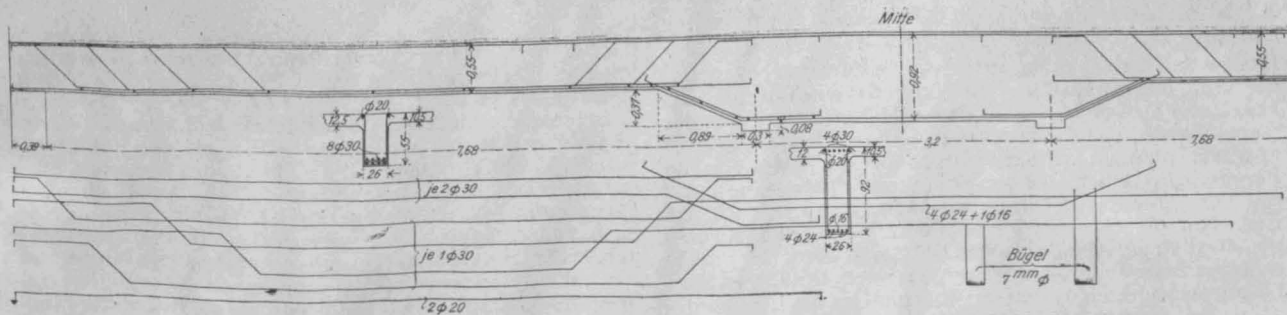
Ausbildung der Deckenbalken der Decke über dem Erdgeschoß des Verbindungsbaues.
